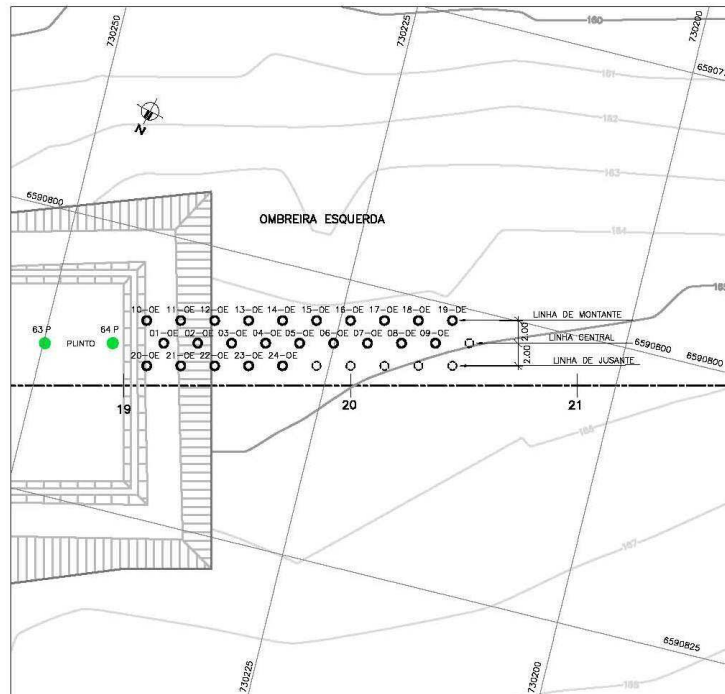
Planta baixa com a localização das injeções na ombreira esquerda
